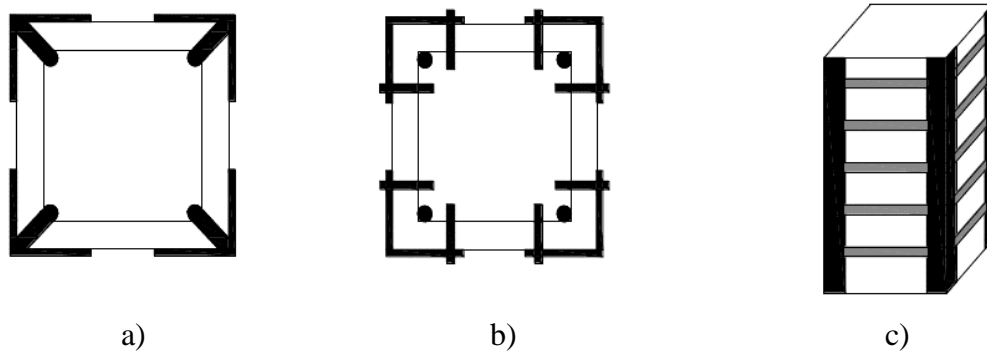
Reforço de pilares: a) cantoneiras fixas à armadura com soldaduras; b) cantoneiras fixas com buchas metálicas; c) cantoneiras ligadas através de barras soldadas; adaptado de Appleton e Gomes (1997)
